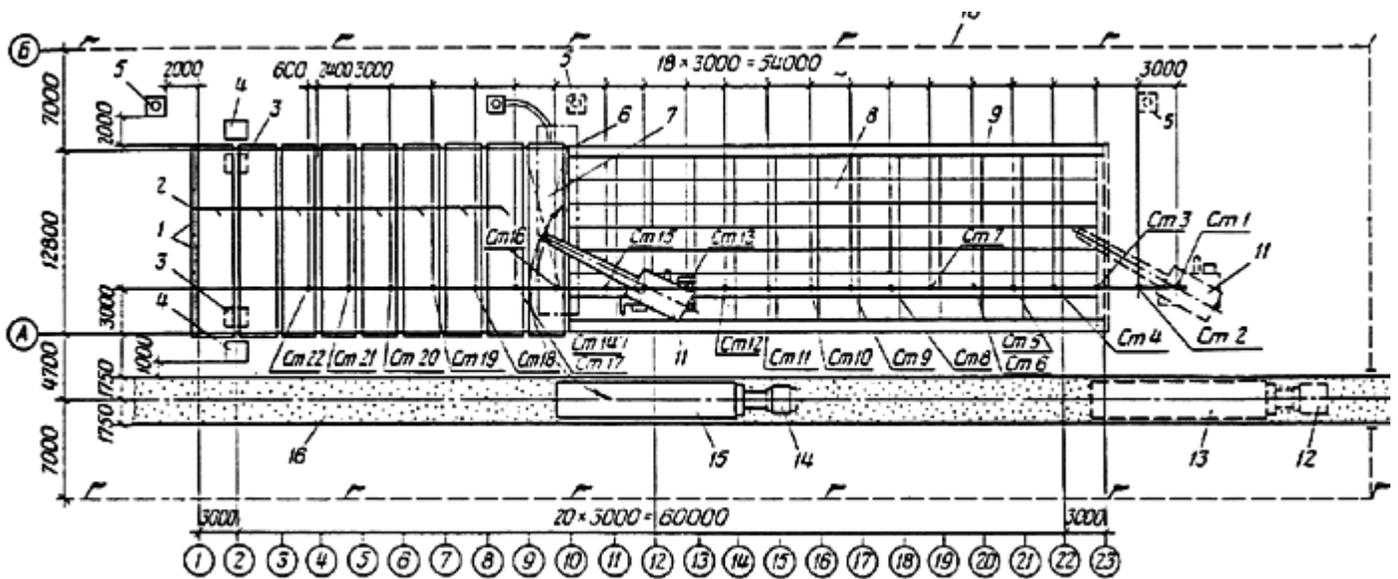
Схема демонтажа конструкции и организации рабочей зоны:
